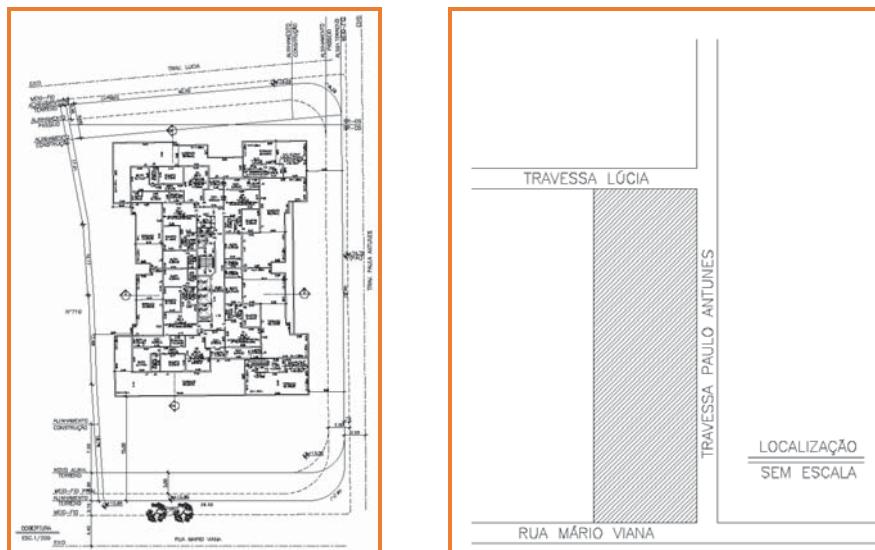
Cobertura e Localização – Fonte: Projeto Legal
